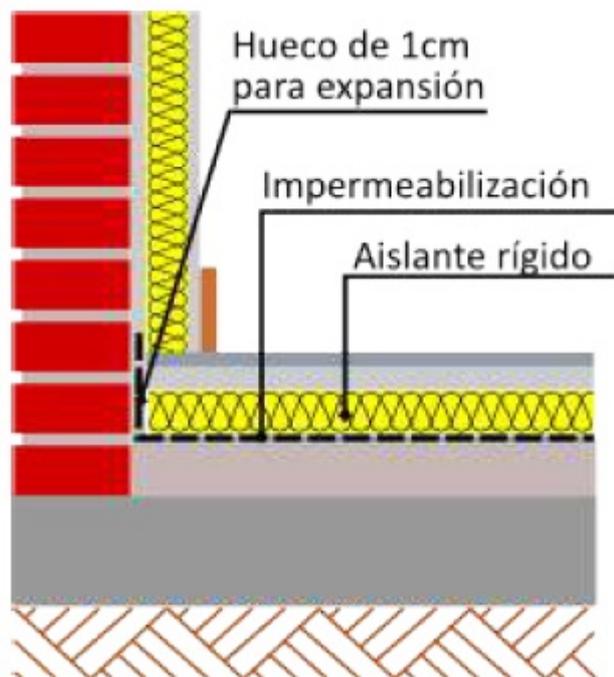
Esquema de rehabilitación de suelos con impermeabilizante bajo aislante térmico.
